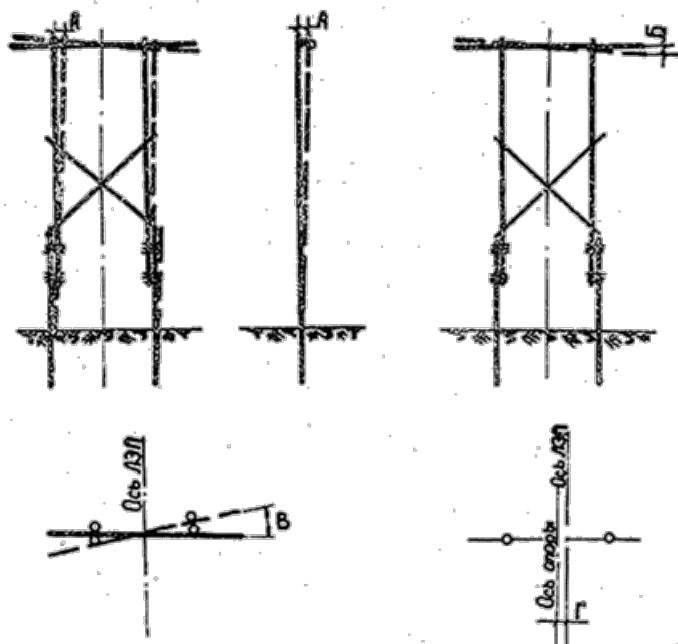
Нормы и допуски на установку деревянных опор
